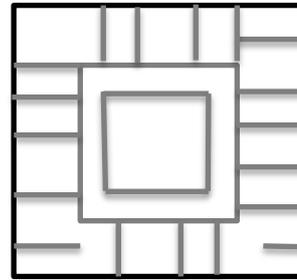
Planta y subdivisión de Esvástica. Elaboración Propia.
